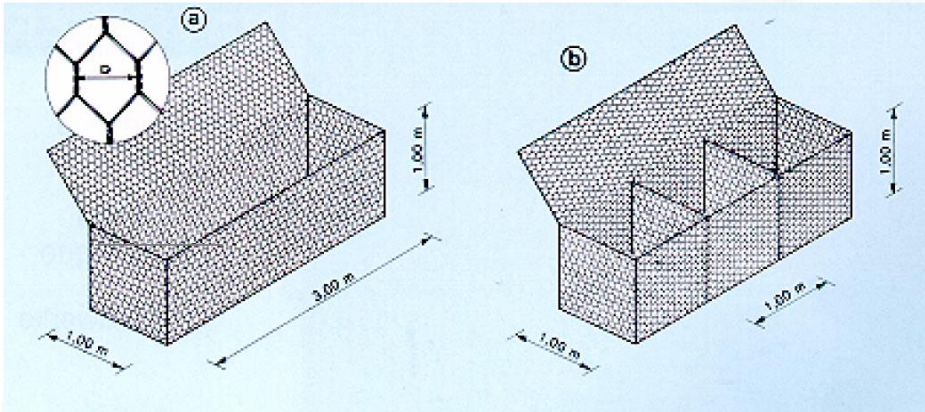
elemento prismatico riempito, successivamente, con ciottoli o pietrame
